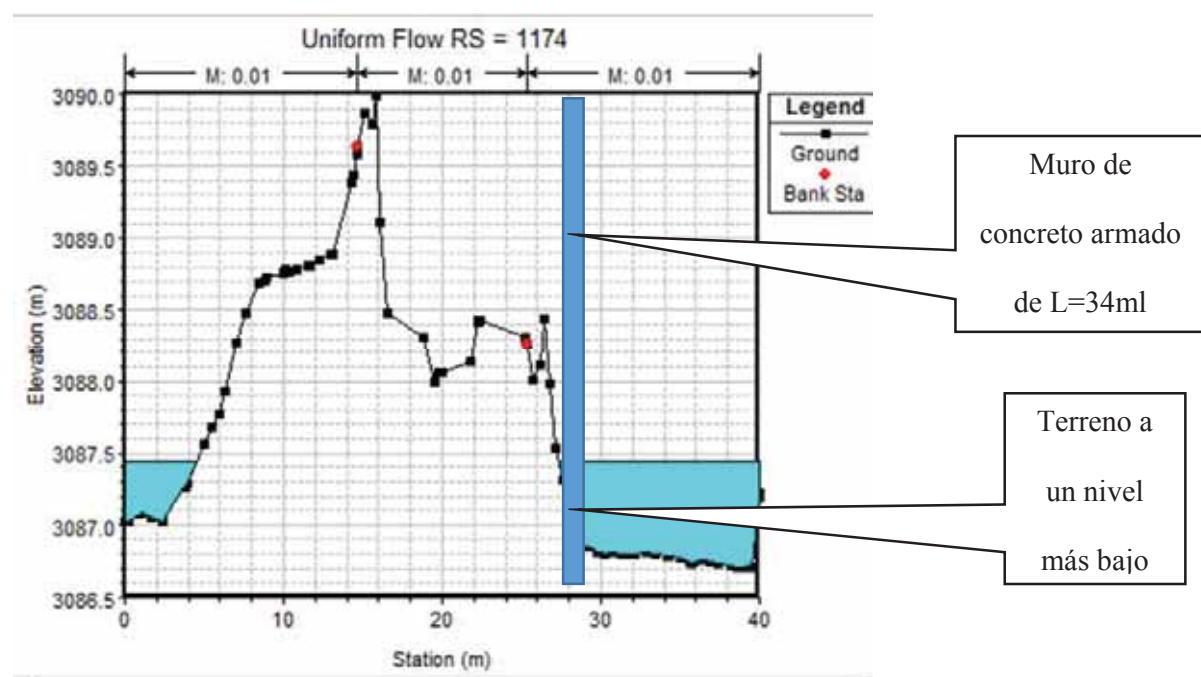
18 Planteamiento Hidráulico solucionando el muro de contención.
